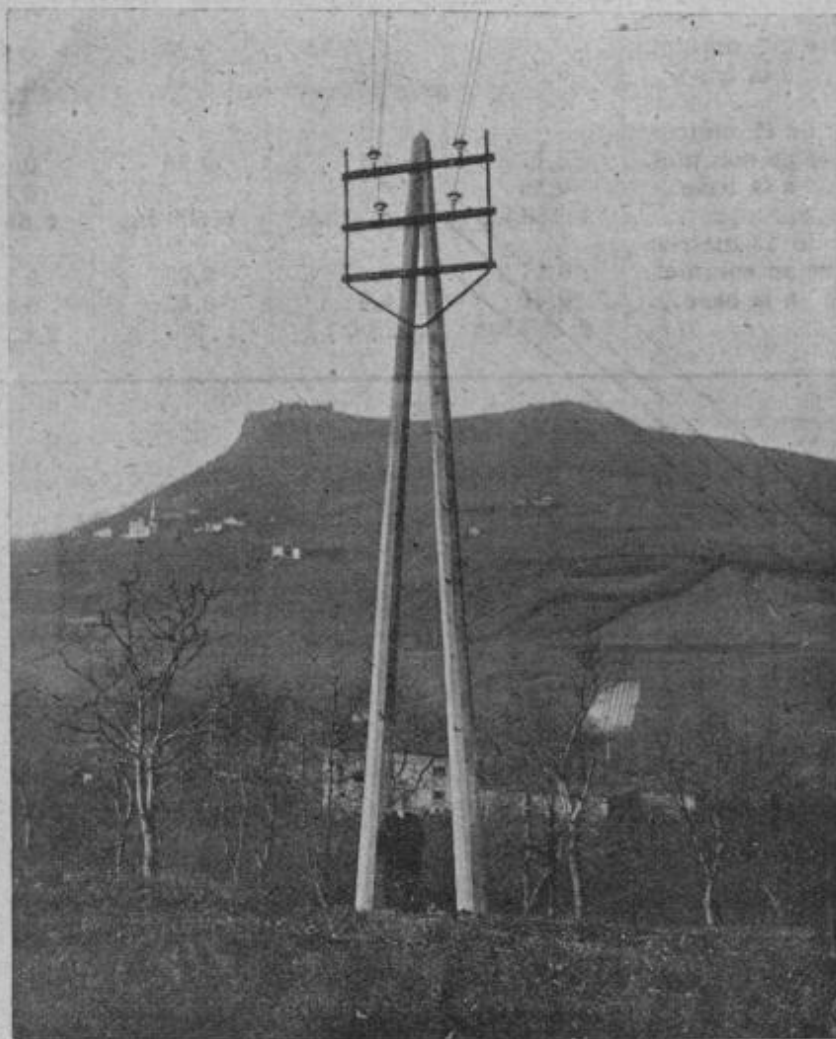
Poteaux tubulaires tronconiques en ciment armé.
